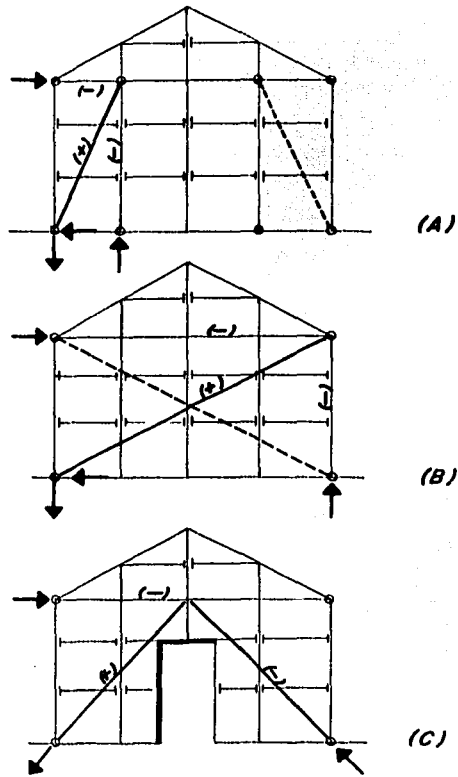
Disposición del contravento en los muros extremos.
